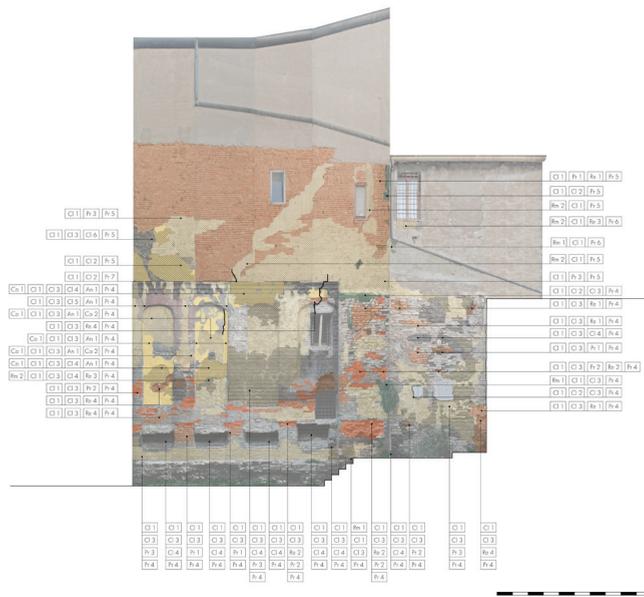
Ipotesi di restauro sulle murature della parte absidale della chiesa
